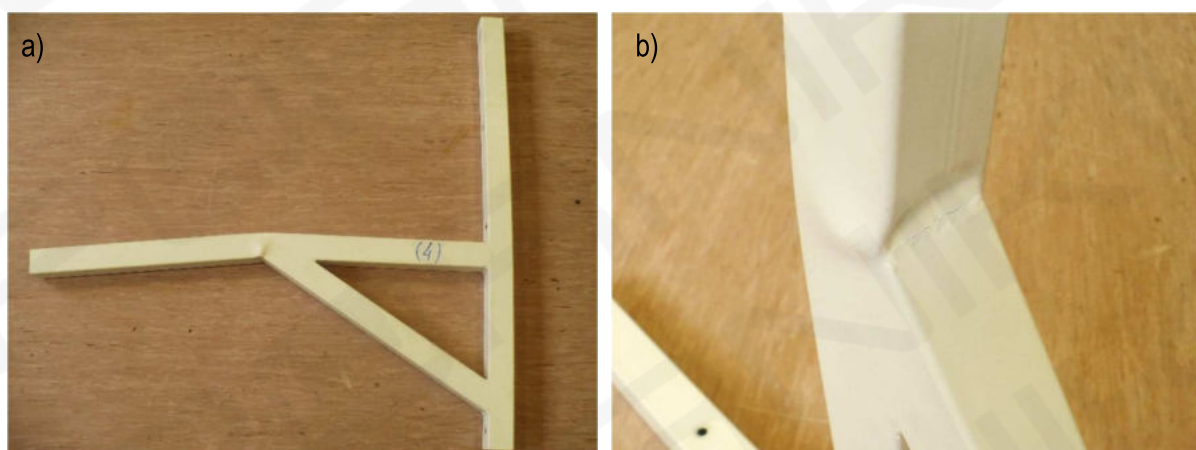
Widok zniszczonego elementu P1: a) widok ogólny, b) miejsce zniszczenia
